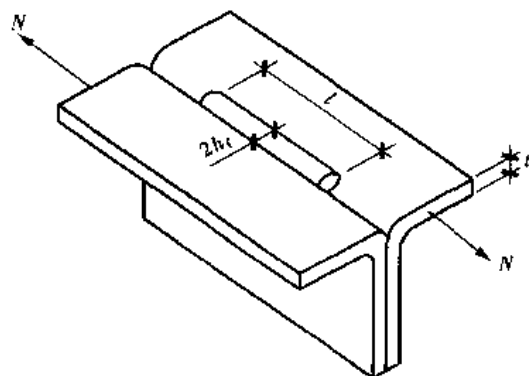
端缝受剪的单边喇叭形焊缝
